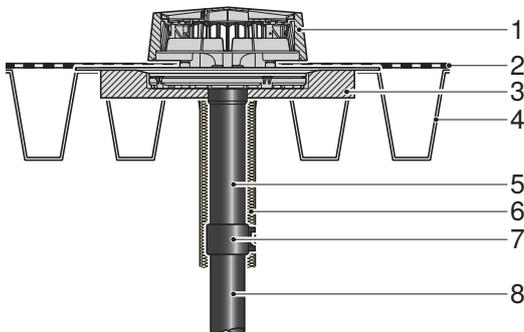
Монтаж на неизолированной легкой кровле с фартуком Geberit Pluvia
